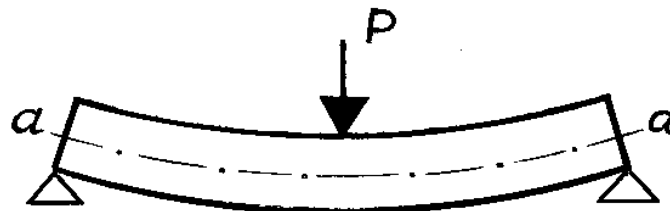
Схема роботи бетонної балки на двох опорах під дією поперечної сили: P – поперечна сила; $a-a$ – нейтральна вісь
